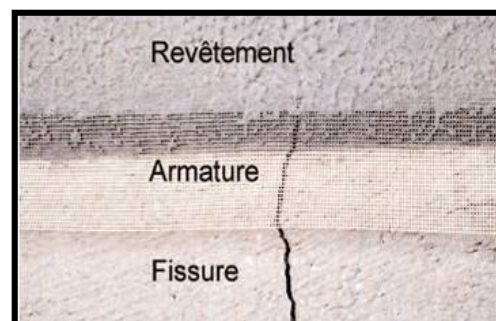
Pontage d'une fissure avec incorporation d'une armature
